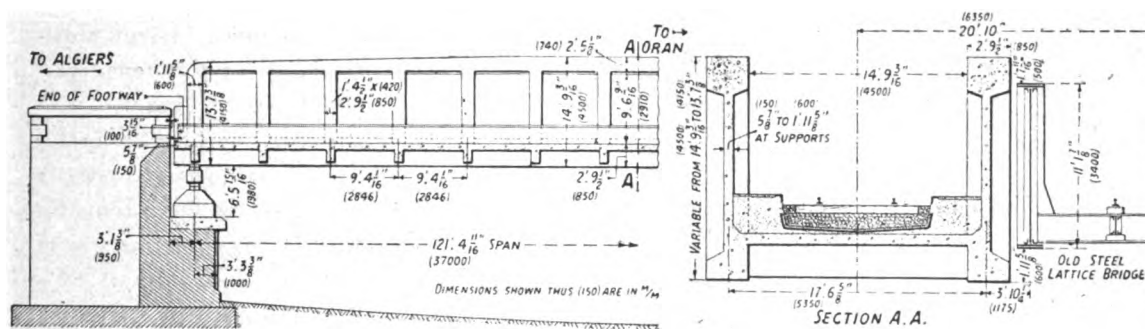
Mezza sezione longitudinale e sezione trasversale.
